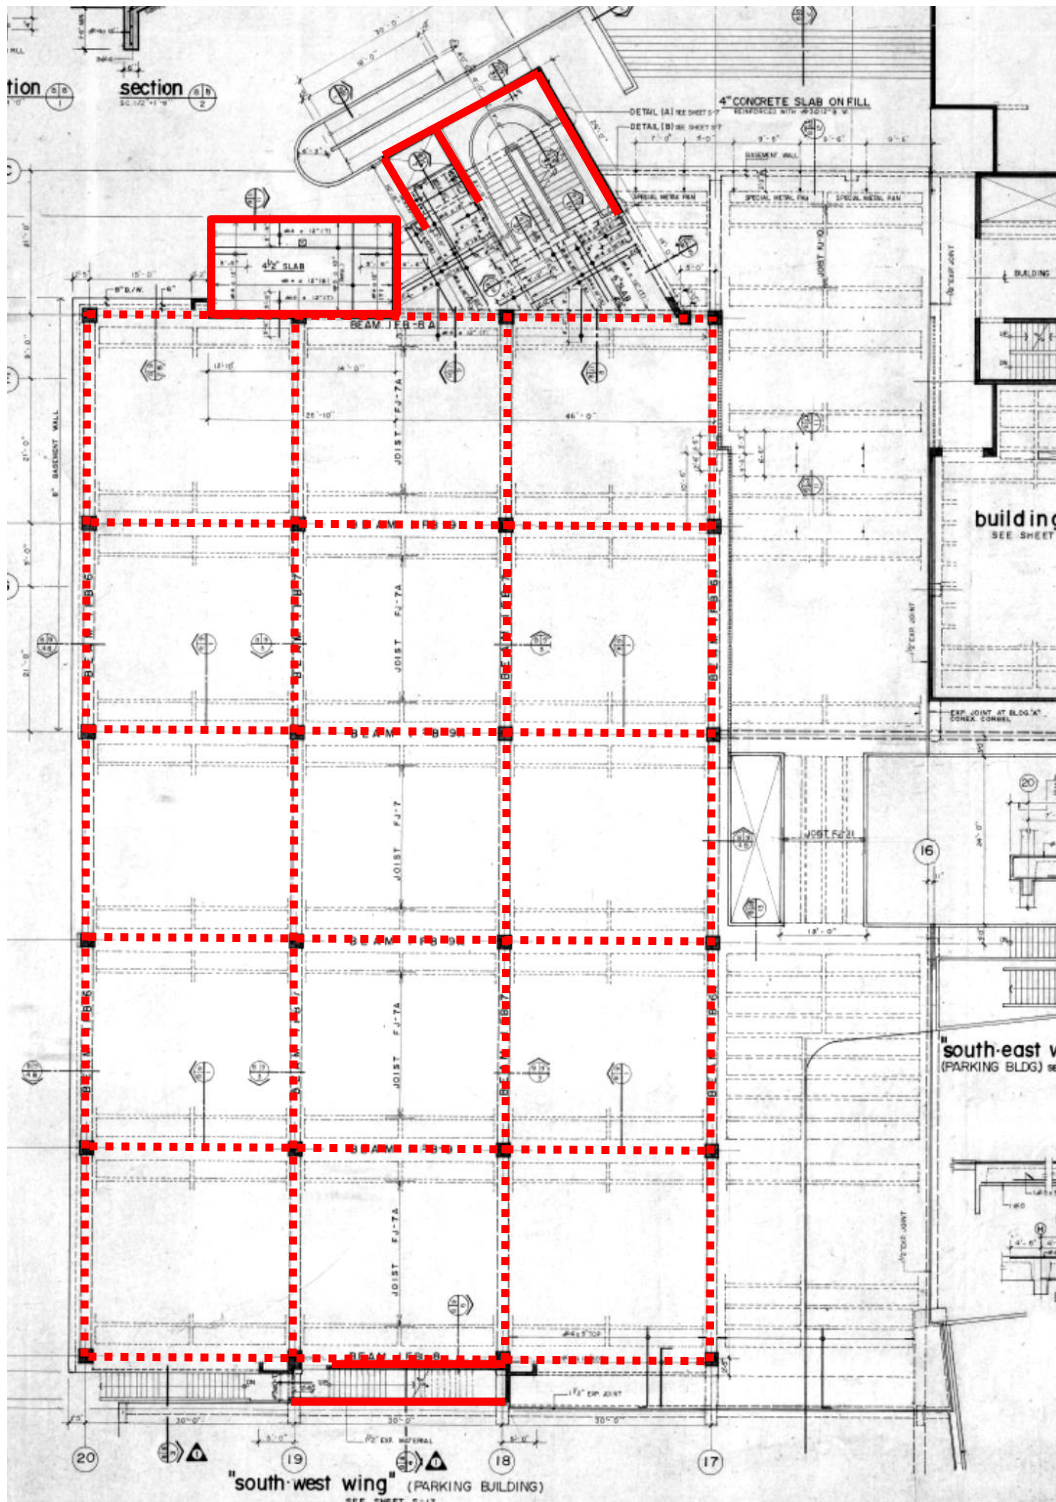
, Planta arquitectónica de primer nivel Edificio Este (B).
